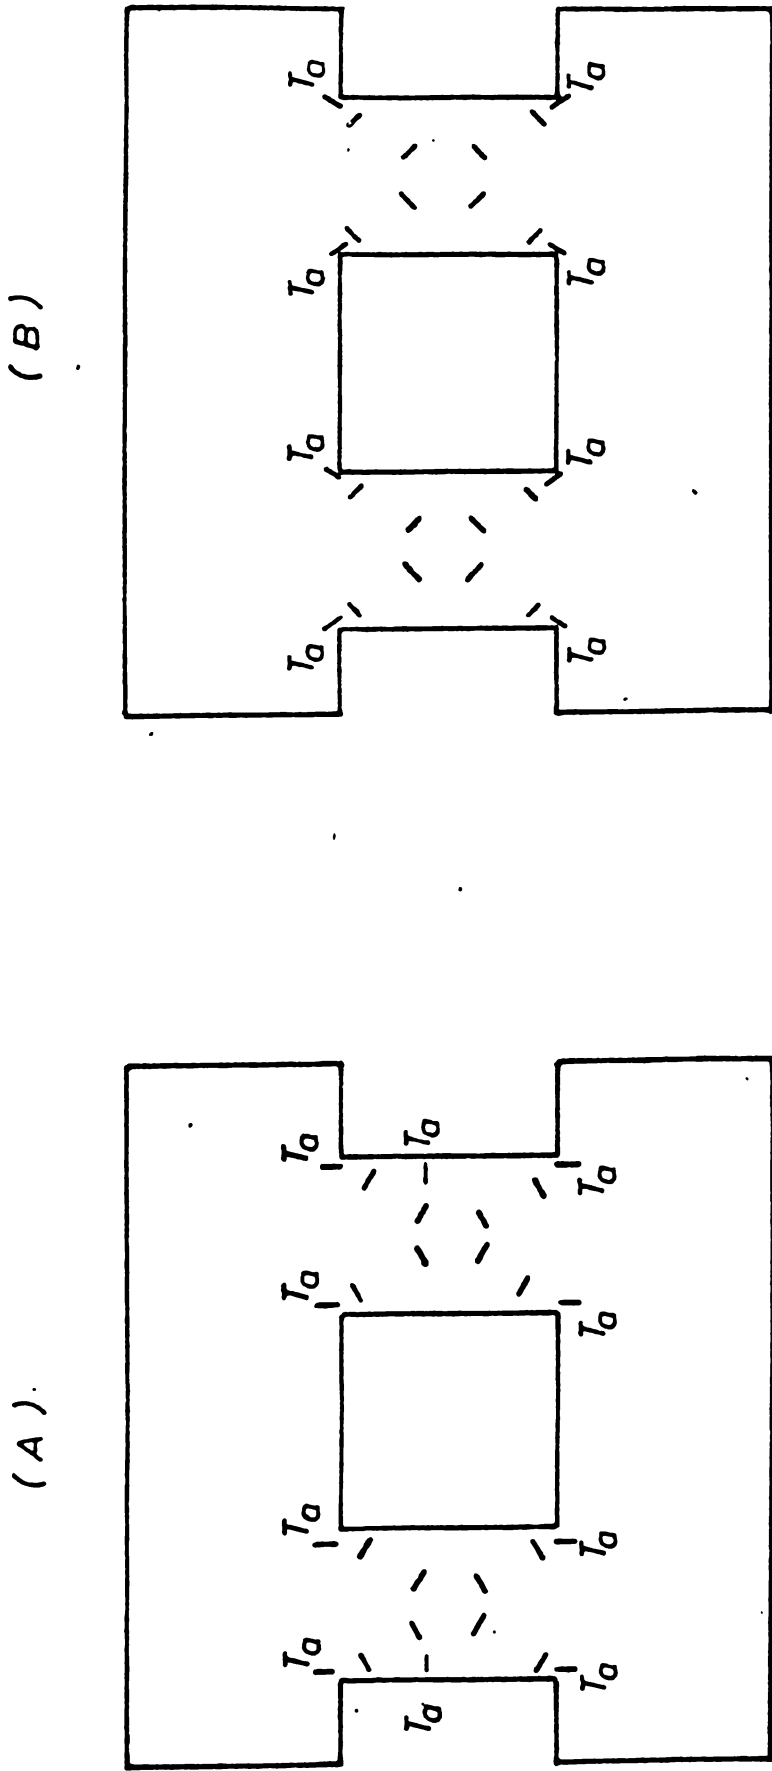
(A) REPARTIZAREA TRADUCTORILOR PE ARMATURA SI PE BETON LA ELEMENTELE
